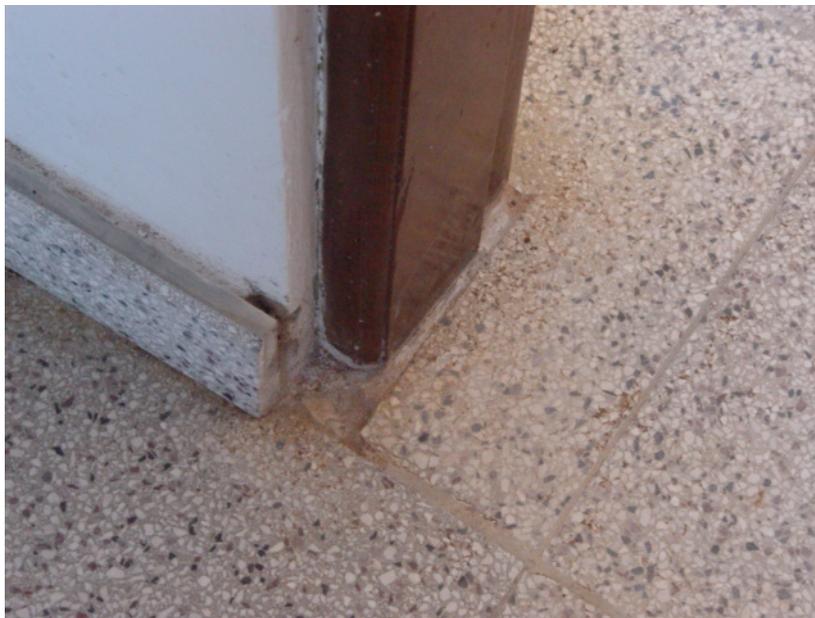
y 22. Obra III: Planchas de granito reconstituido, con fisuras.
